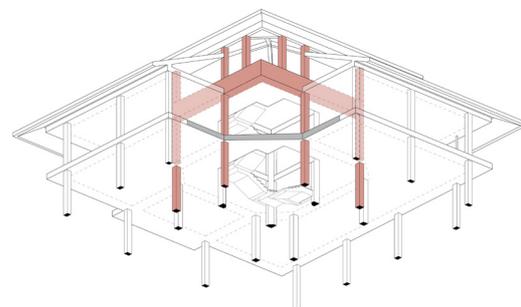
Ipotesi relativa alla soluzione strutturale prevista. Vista assonometrica
